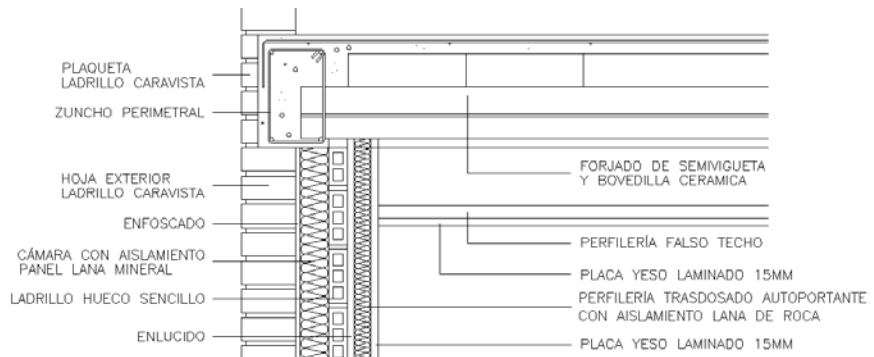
Detalle encuentro fachada - forjado. Fuente propia
